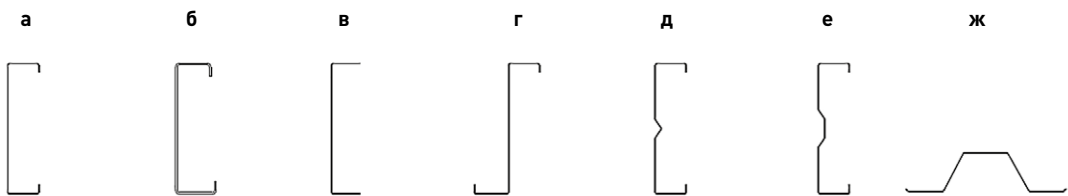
Основные типы сечений холодногнутых профилей [1]: а – С-образное равнополочное сечение (С-профиль); б – С-образное неравнополочное сечение (С-профиль); в – швеллерное сечение (швеллерообразный профиль); г – Z-образное сечение (Z-профиль); д – Σ -образное сечение (Σ -профиль); е – Σ -профиль с вытянутым вдоль стенки рифом; ж – П-образное сечение (Ω -профиль)
